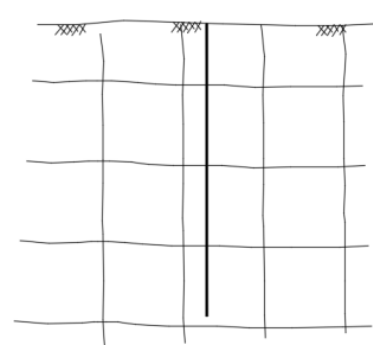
Perforación sin intersectar las discontinuidades. Adaptado de "Construction and design of cement grouting" de Houlsby, A.C. (1990).
